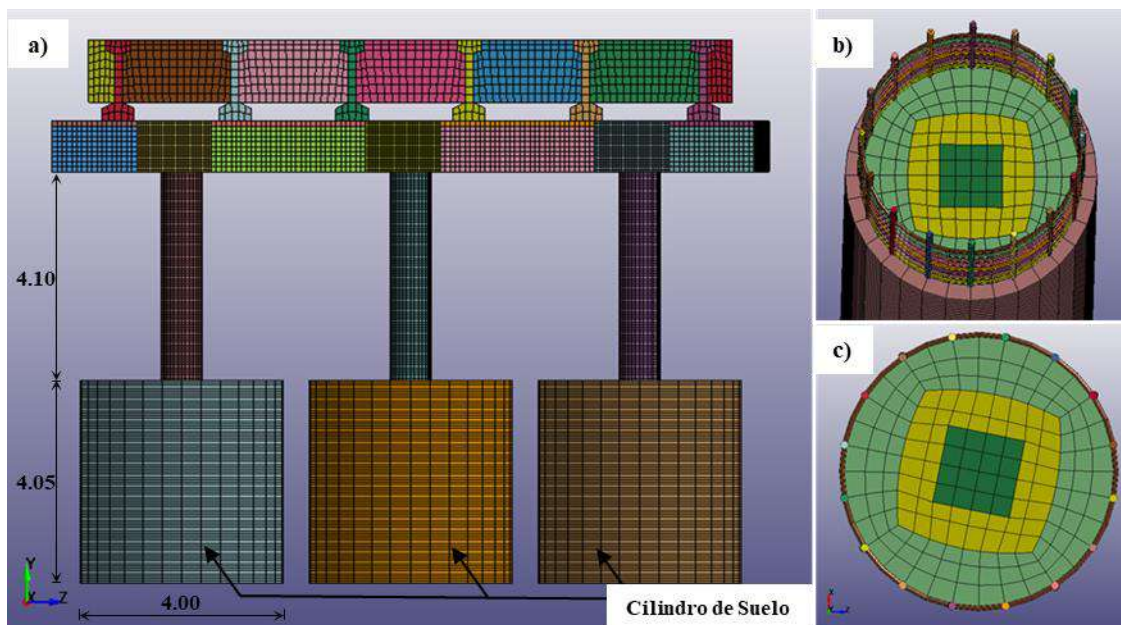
a) Modelo de elementos finitos del puente de calle Paso. b) Armadura de refuerzo. c) Sección transversal de las columnas.
